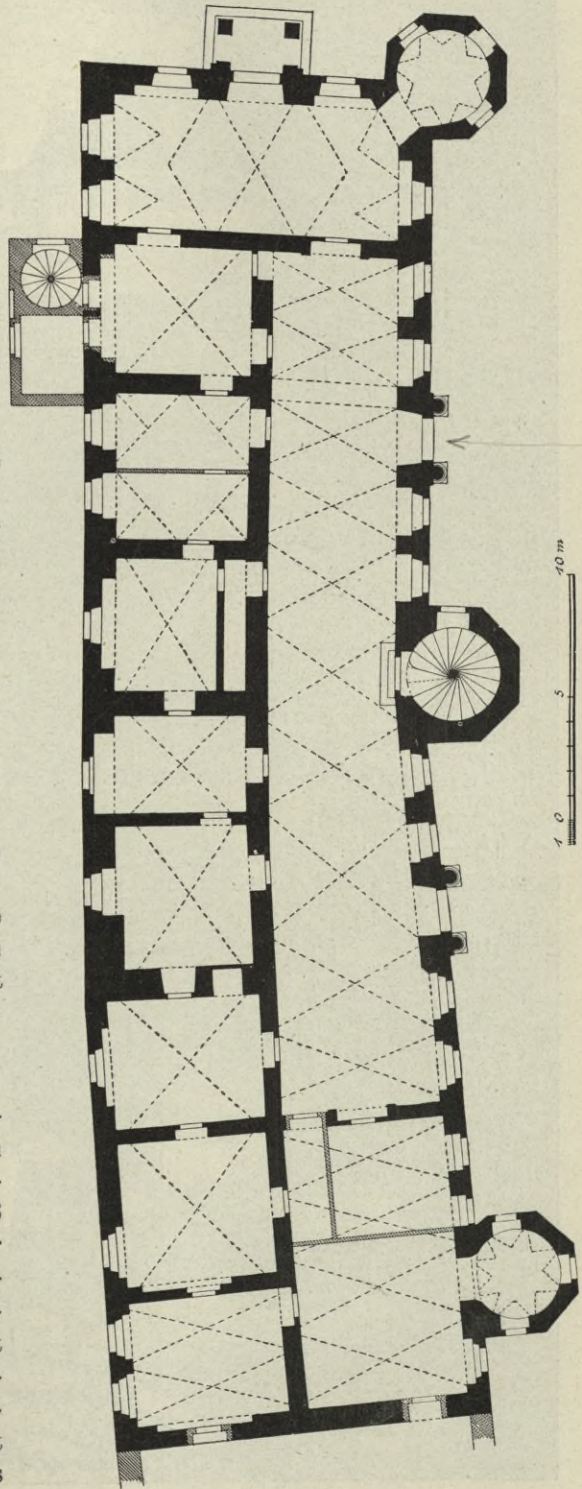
Schloss Hermsdorf, Grundriss des Erdgeschosses.
